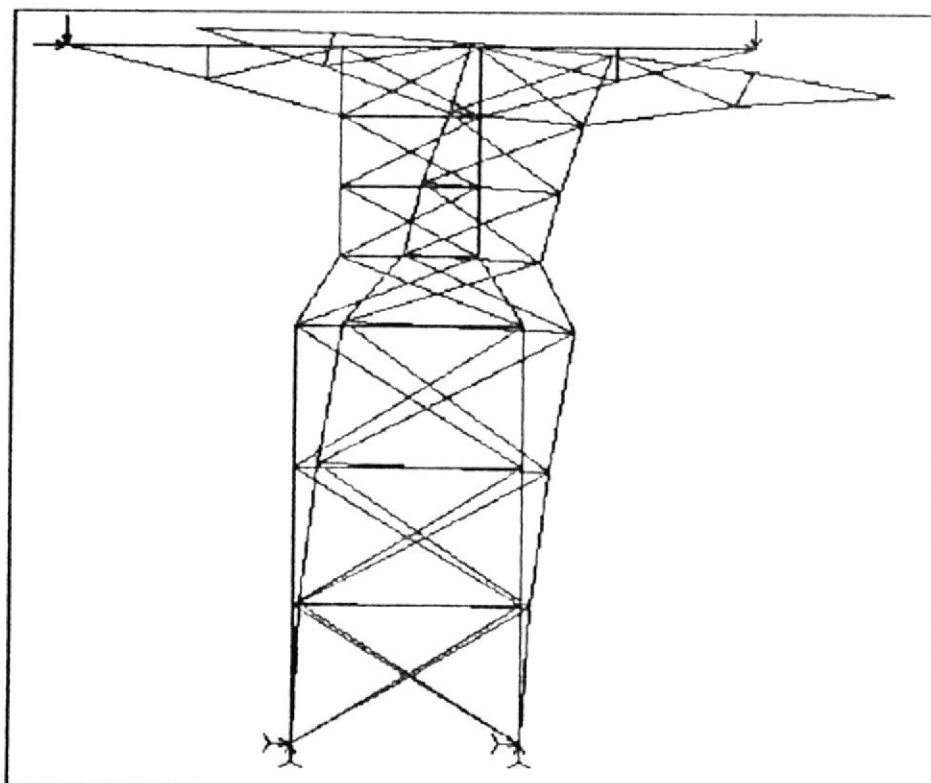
ESTRUCTURA PLANA DEFORMADA.
